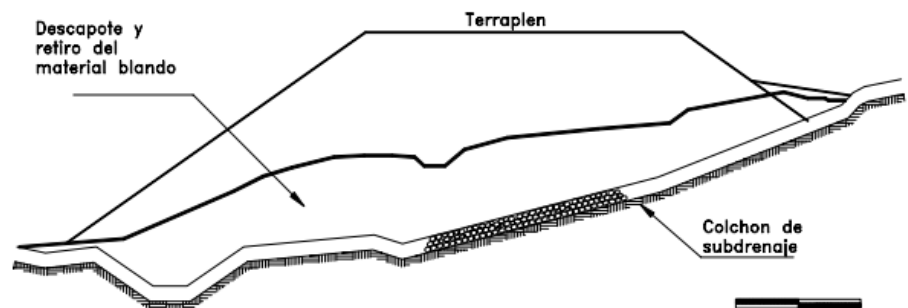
Diagrama de un colchón de drenaje colocado debajo de un terraplén
